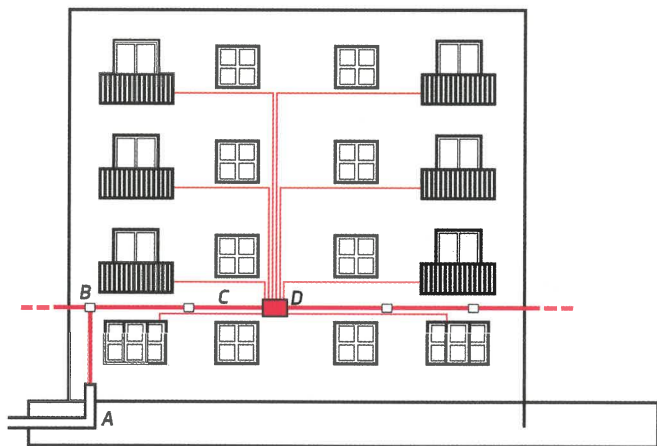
Instalación de red FTTH por fachada. A. Salida lateral; B. Infraestructura de fijación a la fachada; C. Cableado de fachada; D. Caja terminal.
